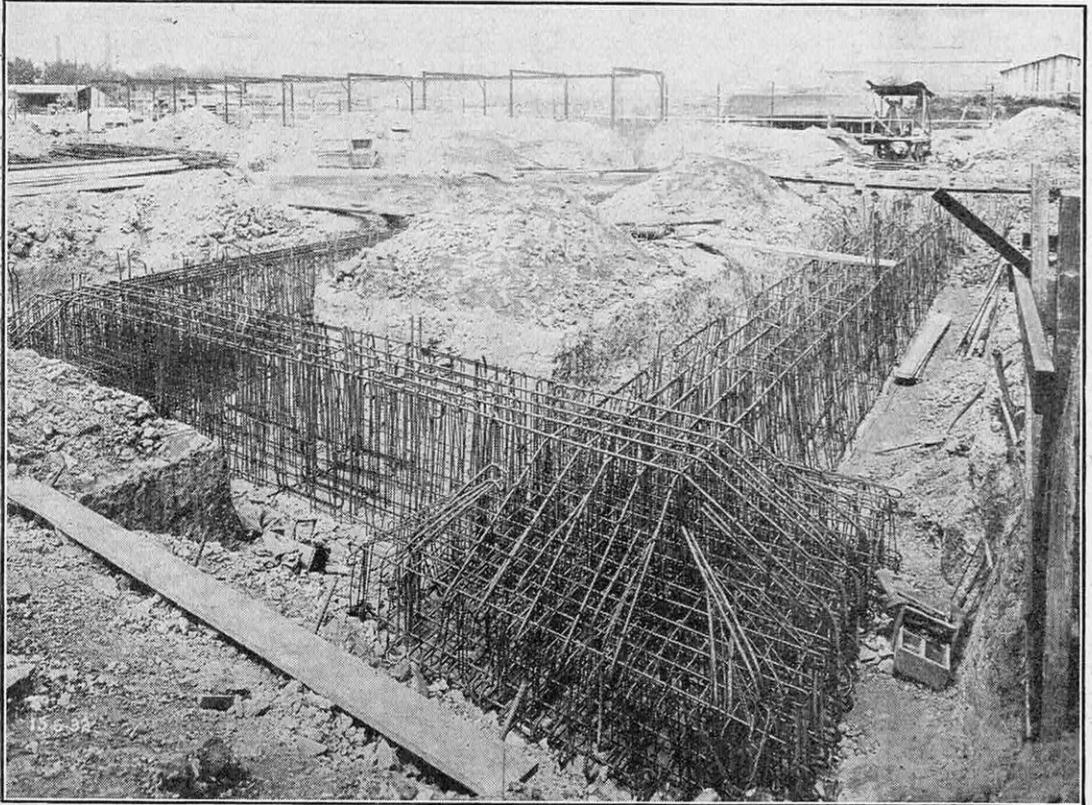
LE FERRAILLAGE D'ENSEMBLE DES FONDATIONS D'UN CORPS DE BATIMENT
